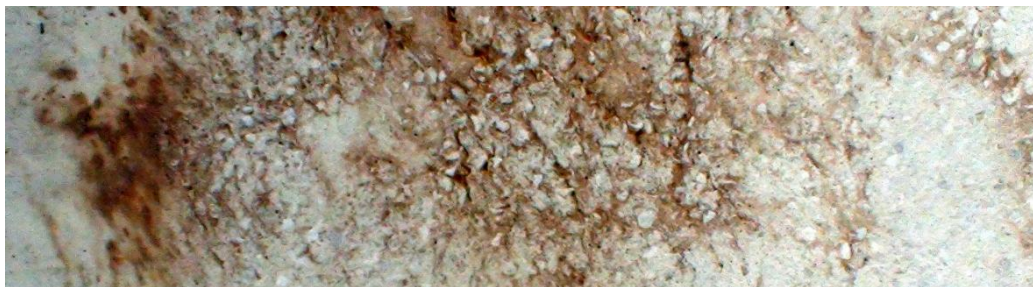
Ejemplo de hormigón con pigmentos dispuestos aleatoriamente en el encofrado.
